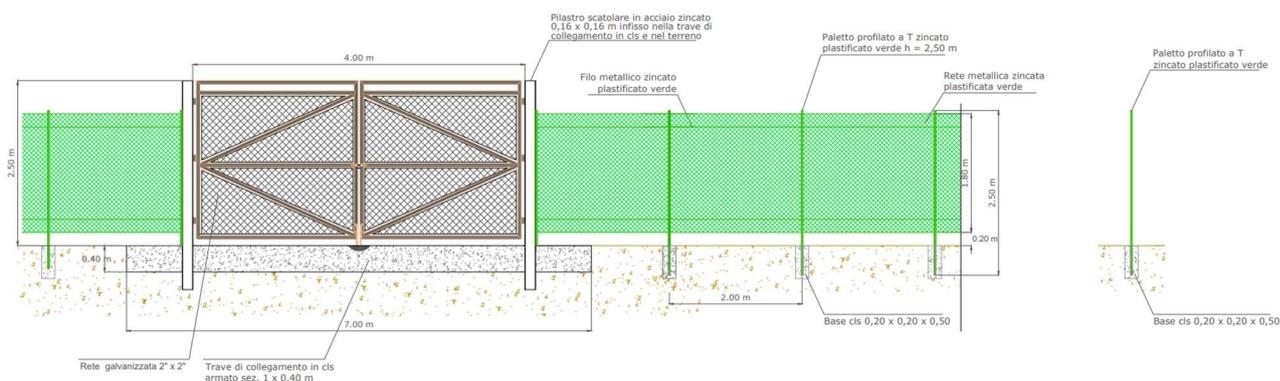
Particolare recinzione lungo il perimetro dell'impianto
